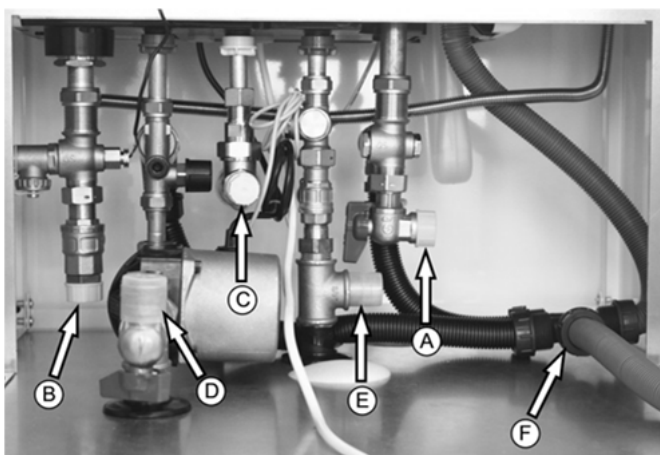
Hydraulisches Anschluss-Schema rechts/links/rückseitig
